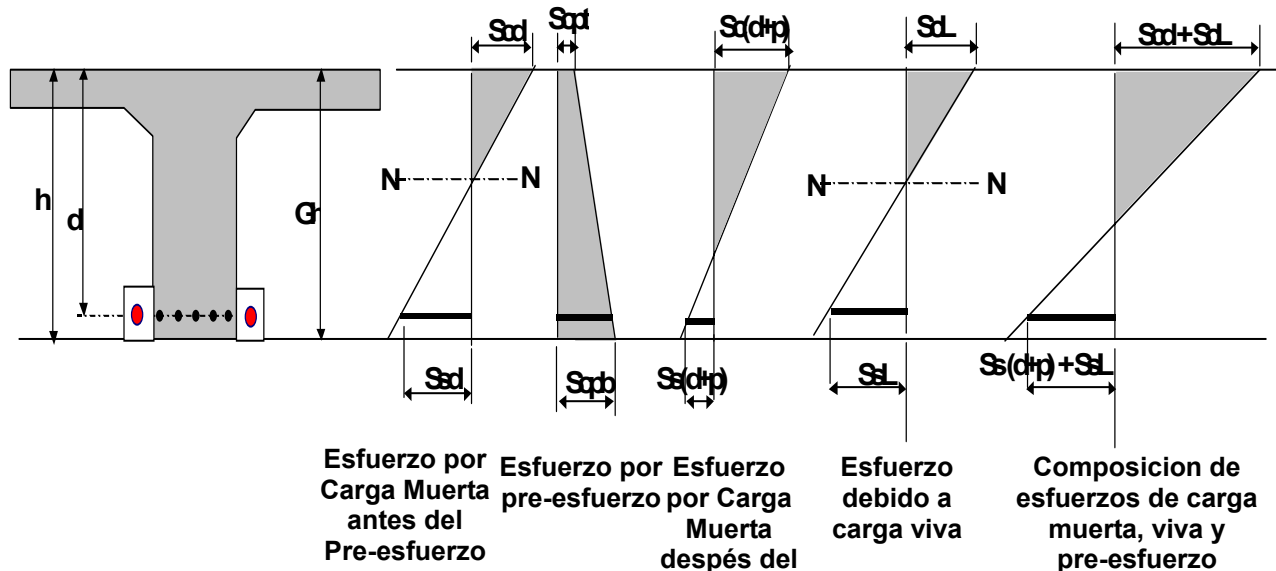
Esfuerzo de las vigas RC debido a Adición de Cable Externo
